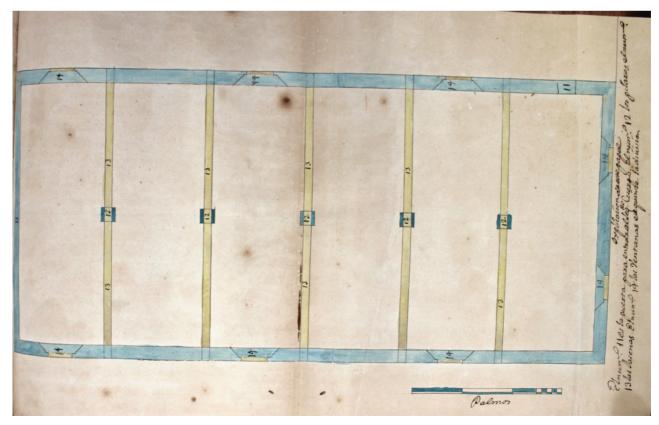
Plano planta superior Pósito de Orihuela. Proyecto de J. V. Alcayde 1755 (A.M.O.) D 571, fol. 62
